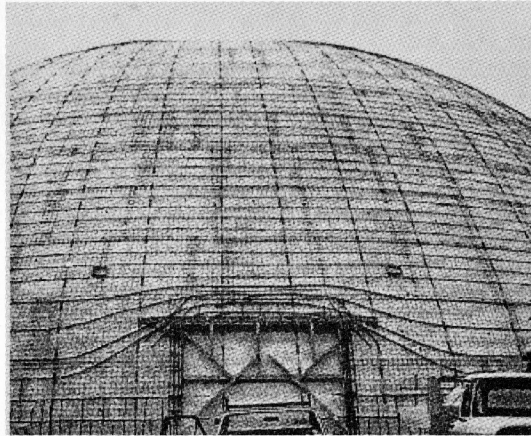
Con todos los refuerzos en su lugar, se procede con la colocación de concreto lanzado.
